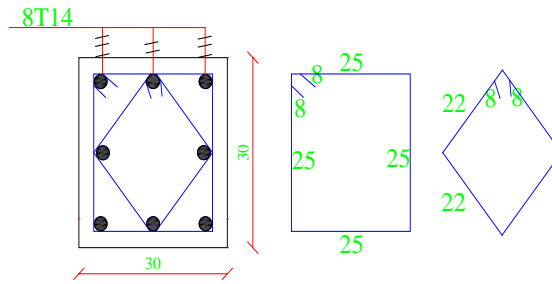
ferrailage des sections de la P2-Figure (V.3) : ferrailage des sections de la P3
